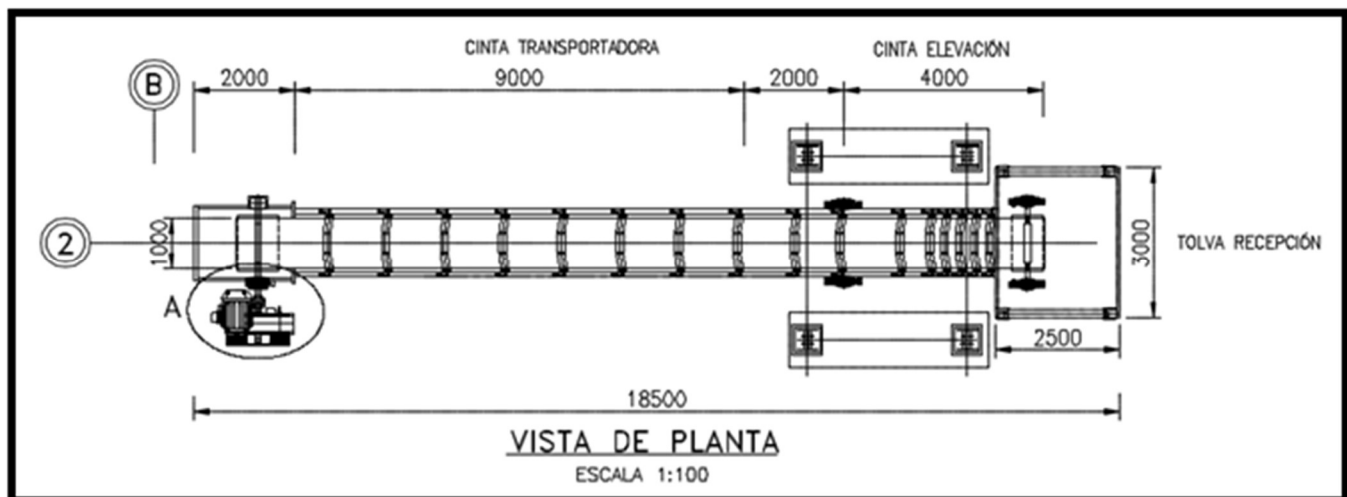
Detalle Área de Recepción - Fuente: elaboración propia
